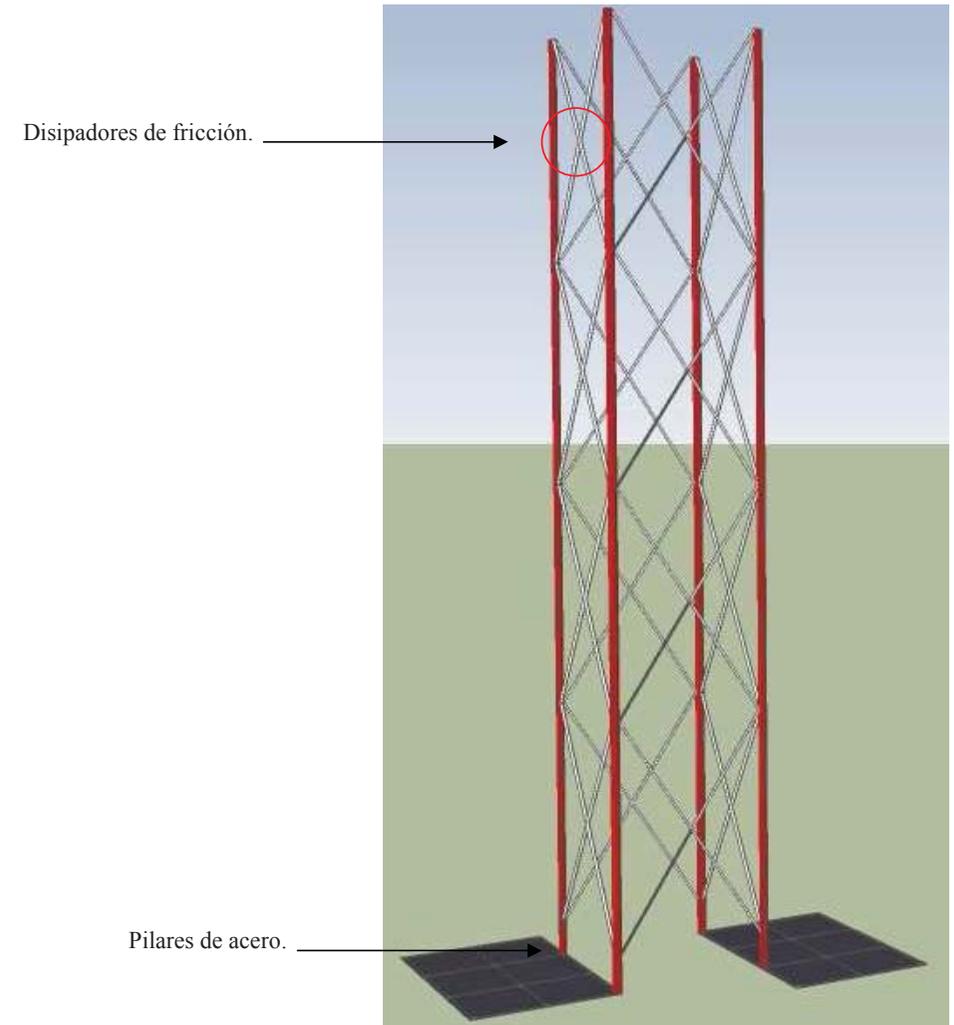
Torre central de arriostramiento. 4 pilares de los volúmenes habitables (a izquierda y derecha) comparten con este elemento estructural. Haciendo a ambas estructuras solidarias.
